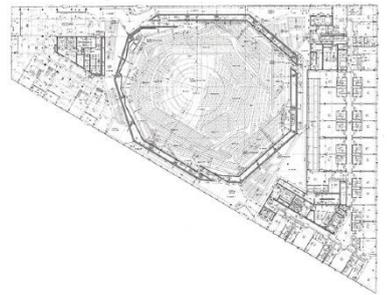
Configuración en planta de la Filarmónica de Hamburgo.
